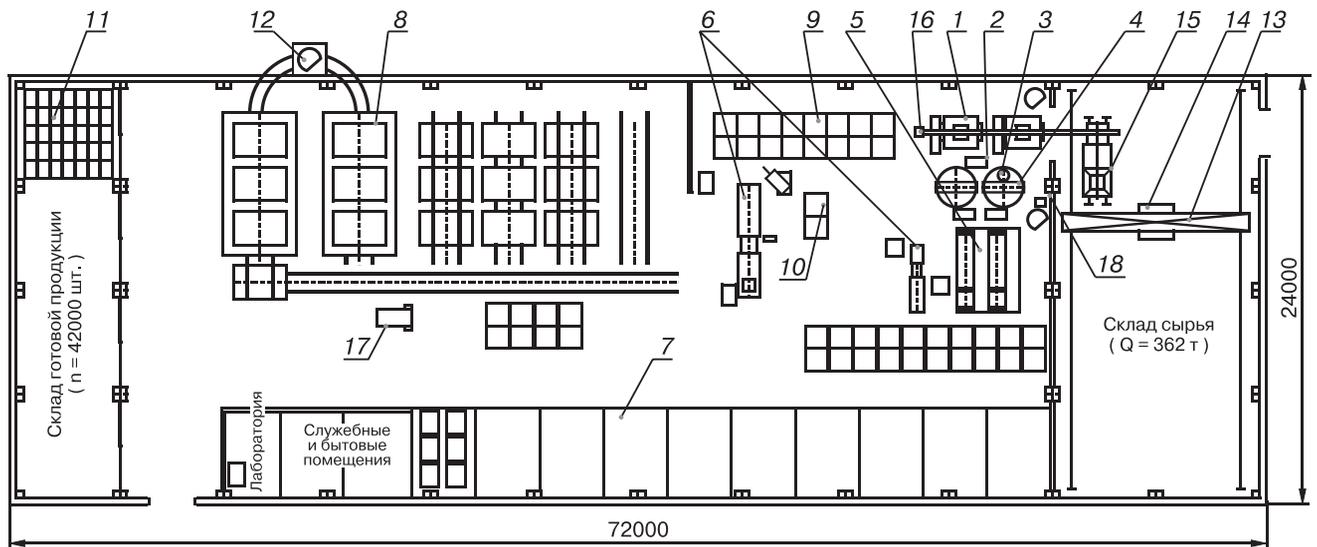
План производственного корпуса мини-завода МКЧ-3000 с применением шаровых мельниц мокрого помола и камерных газовых печей. 1 – мельница шаровая; 2 – насос мембранный; 3 – сито вибрационное; 4 – мешалка пропеллерная; 5 – фильтр-пресс; 6 – линия изготовления полуфабрикатов черепицы; 7 – сушилка камерная; 8 – печь газовая; 9 – поддон для массы; 10 – тележка сушильная; 11 – поддон для черепицы; 12 – труба вытяжная; 13 – кран-балка; 14 – грейфер; 15 – кубель; 16 – тельфер; 17 – электропогрузчик; 18 – насос дивфрагменный
